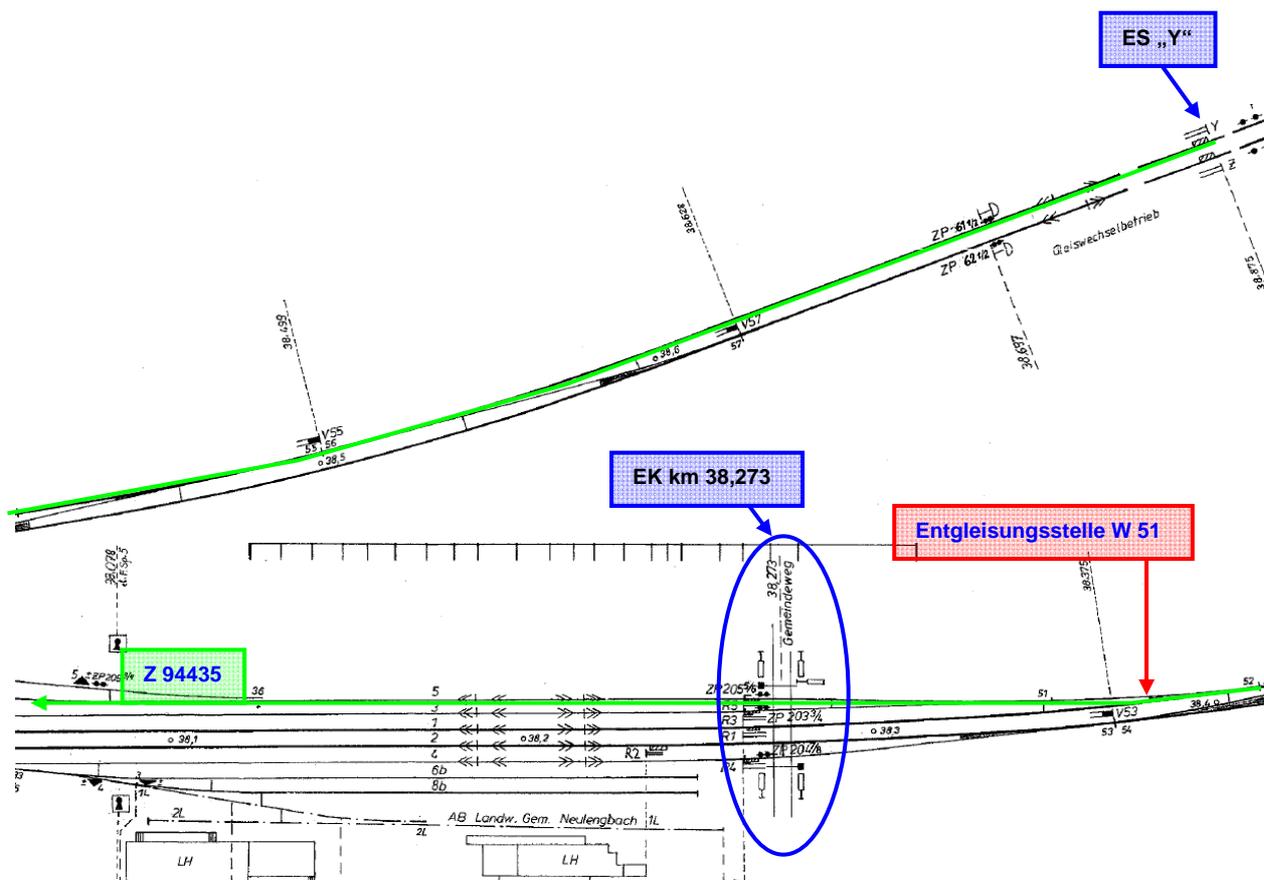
Lageplan Bf Neulengbach mit Entgleisungsstelle
